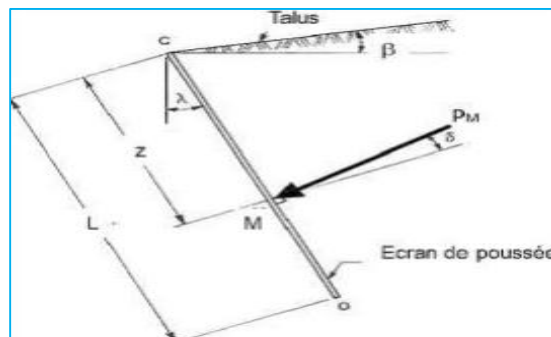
Poussée des terres à la p. (les murs de soutènement ,2013)
